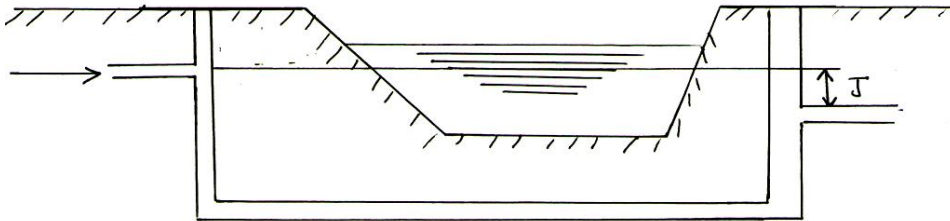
3. Schéma de passage en siphon avec puits verticaux
